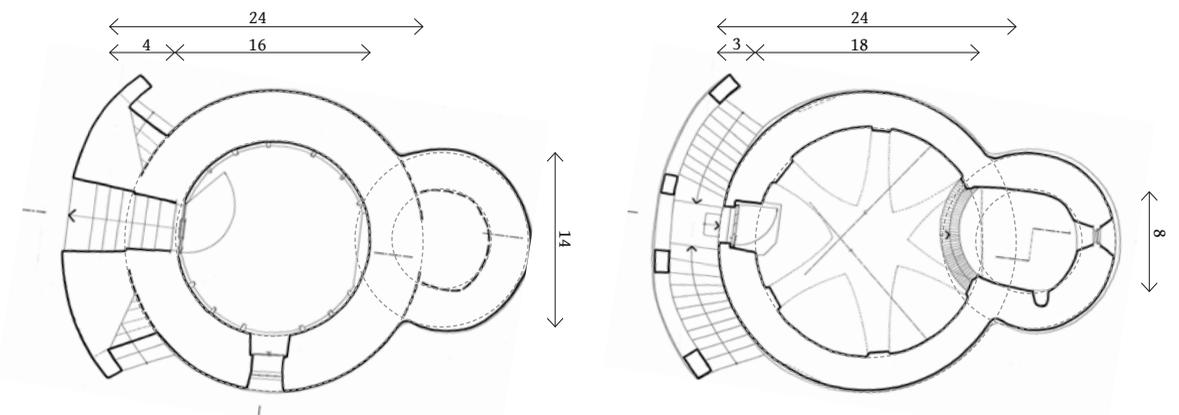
Grundrisse mit den kodierten Hauptmaßen in Fuß. CA 2016.
